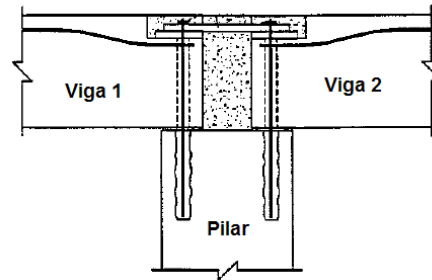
Ligação de continuidade entre vigas através de chapa metálica (adaptada de [46])
